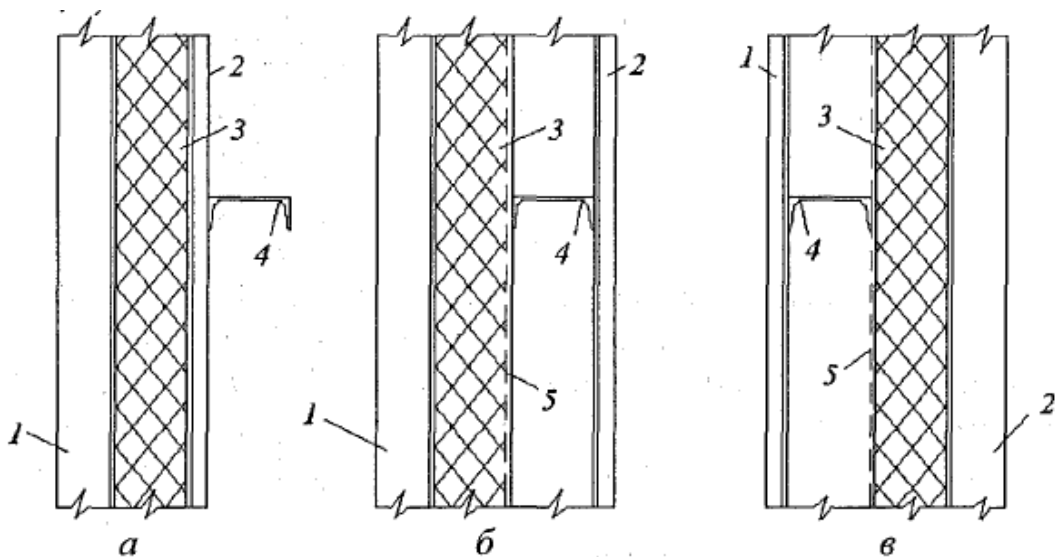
Конструкції утеплених стін із пошаровим монтажем: 1,2 — відповідно зовнішня і внутрішня обшивки; 3 - утеплювач; 4 - ригель фахверка; 5 - монтажна сітка
